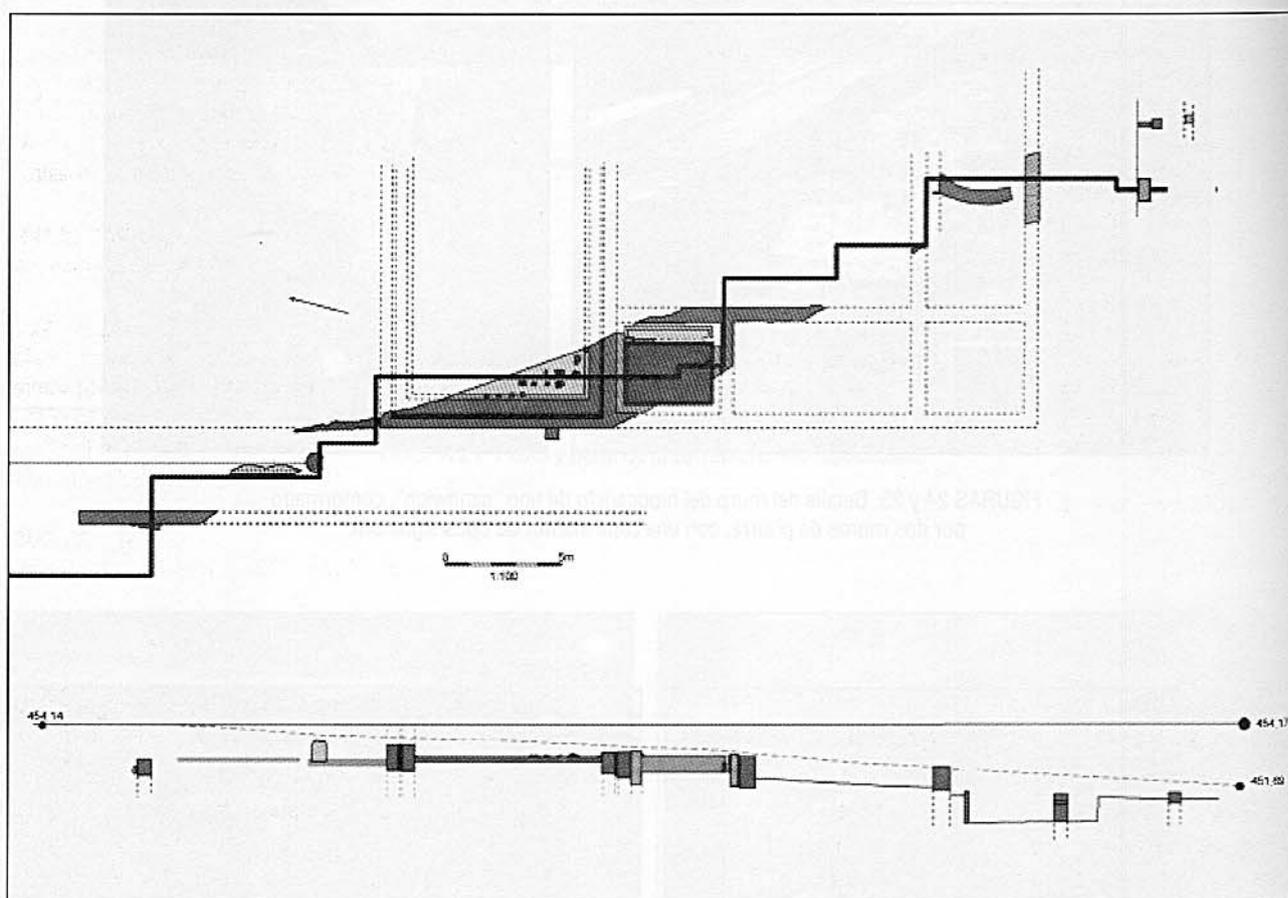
Posible reconstrucción de la planta y perfil del complejo localizado.
